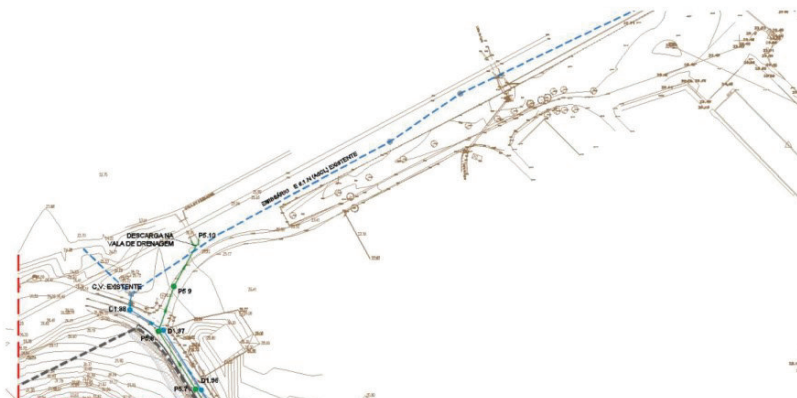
Excerto da Planta da Rede de Gás e caboduto (linhas rosa e azul), no traçado existente – A norte, na antiga EN242 (descl.) traçado paralelo ao do emissário E8.1.N.
